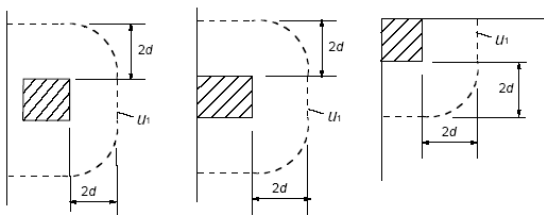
Kritische Rundschnitte um Lasteinleitungsflächen nahe eines Randes oder Ecke
